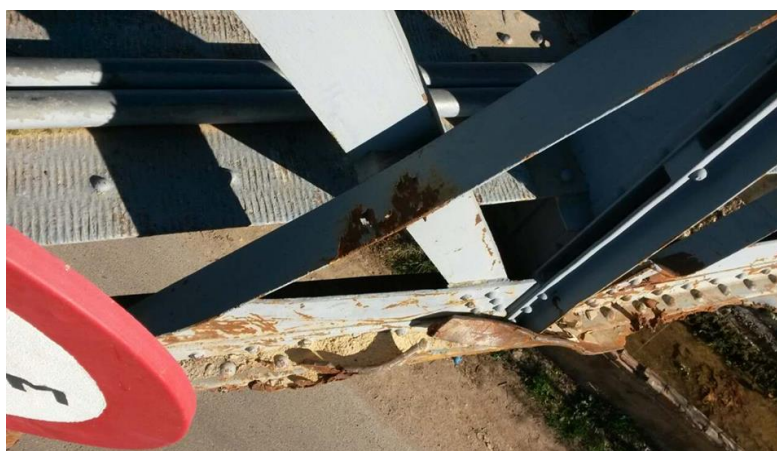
Semelle inferieure de la poutre principale endommagée vers Sebdu vue d'en haut.
